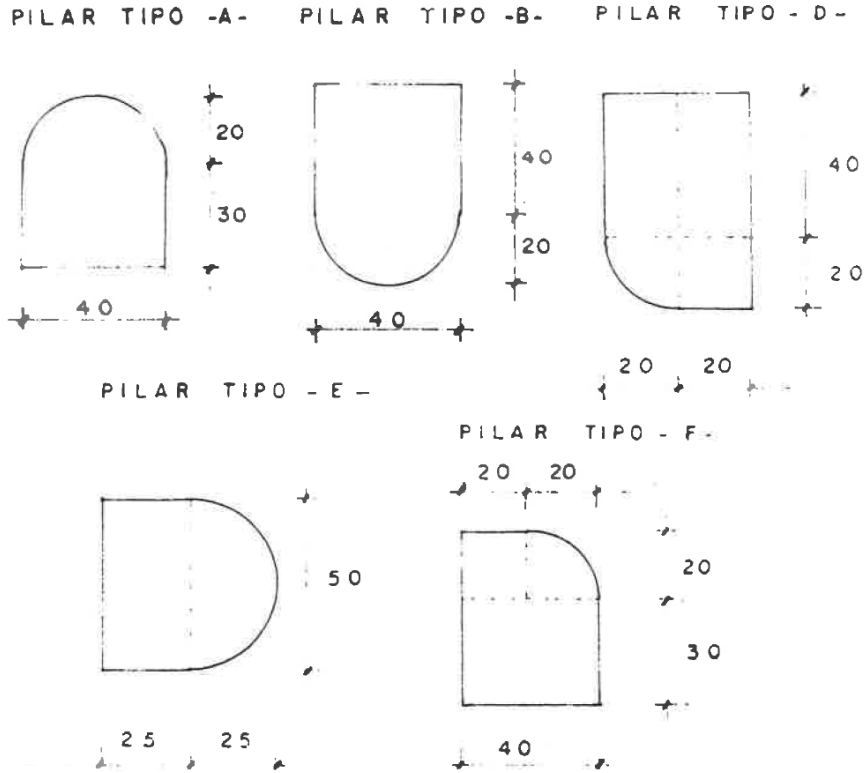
Tipos de secciones de pilares. (Plano de detalles estructurales). [2]
